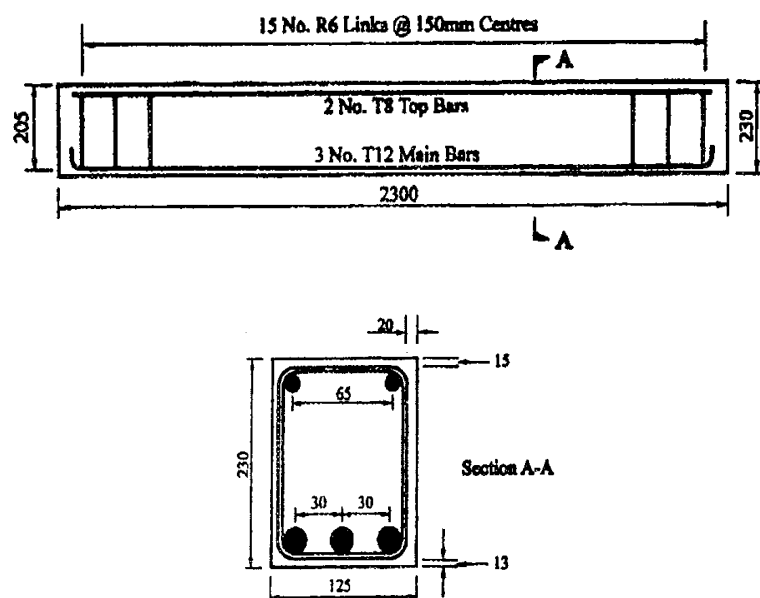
Dimensions des éprouvettes (d'après Barnes et Mays, 1999)
